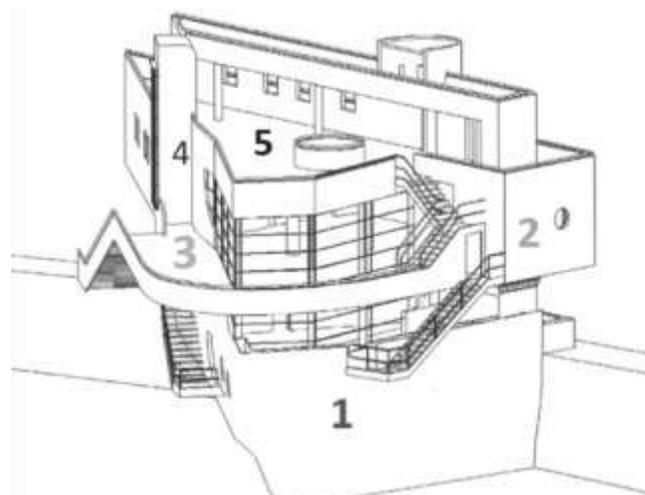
Esquema tridimensional de la reconstrucción según planimetría original. M Cortés Santiago, Chile. (2003).
